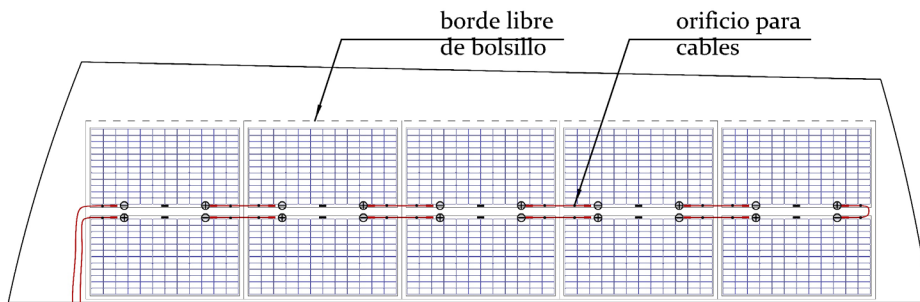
Vista inferior de la cubierta según la primera configuración.
